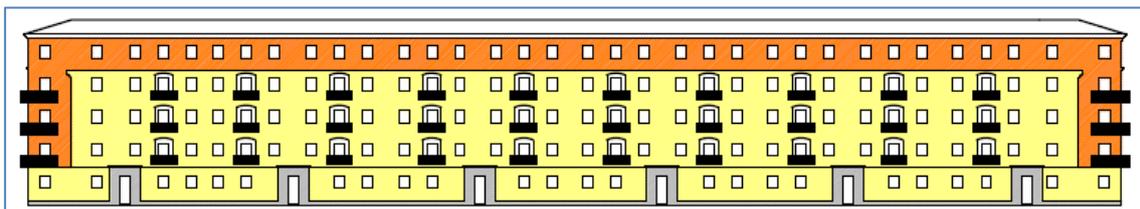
Imagen distribución de fachadas por tipologías en Fachadas Norte y Sur (amarillo revestida, naranja caravista y gris zócalo).
